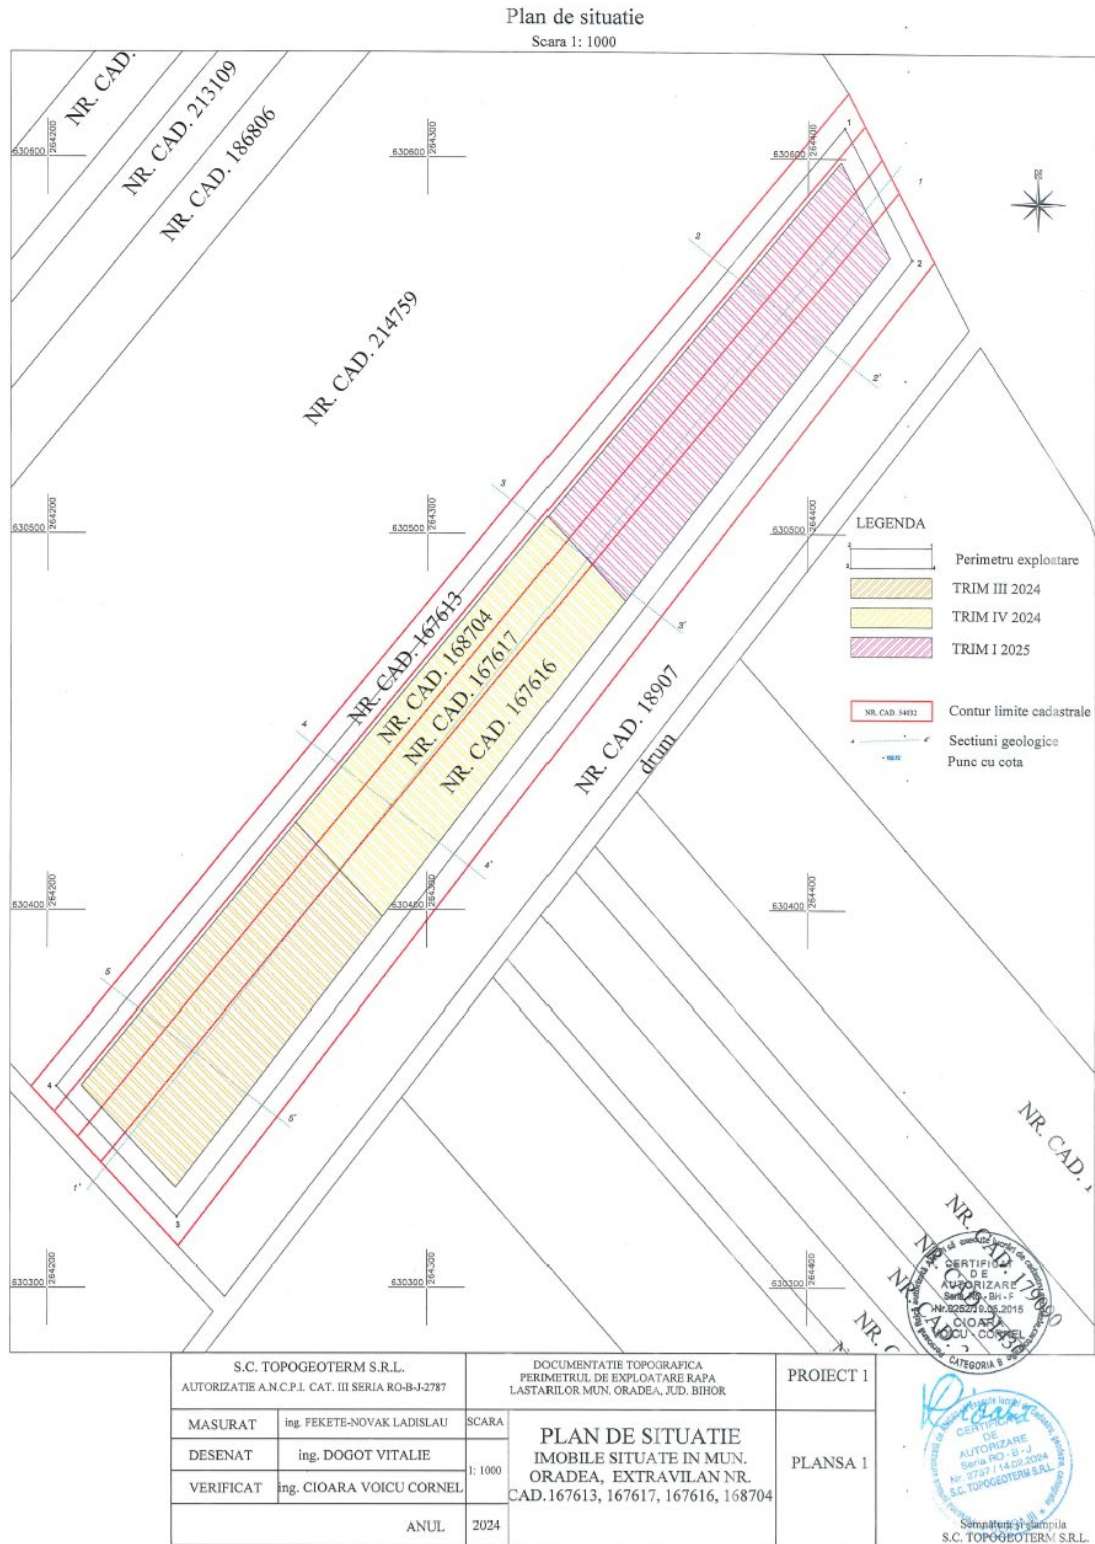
Plan de situație teren identificat prin CF. 167613, 167616, 167617, 168704
